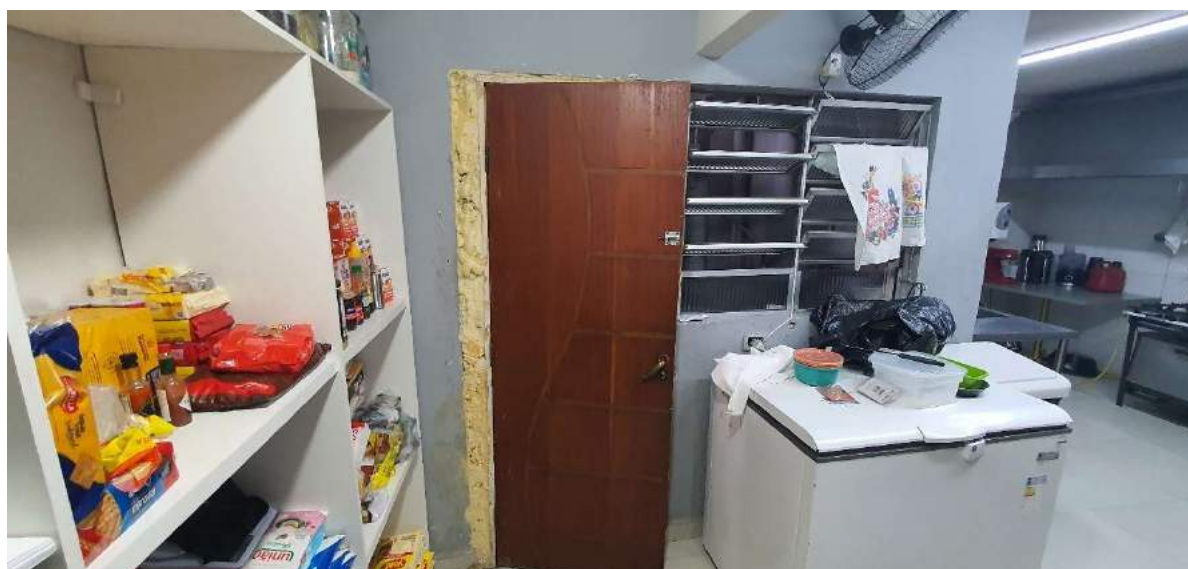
COZINHA, VISTA PARA SAÍDA PARA ESCADA, FALTA GUARNIÇÃO DA PORTA.
